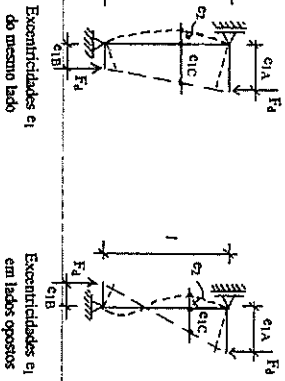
Esquemas estruturais para um segmento de pilar situado entre dois pavimentos
